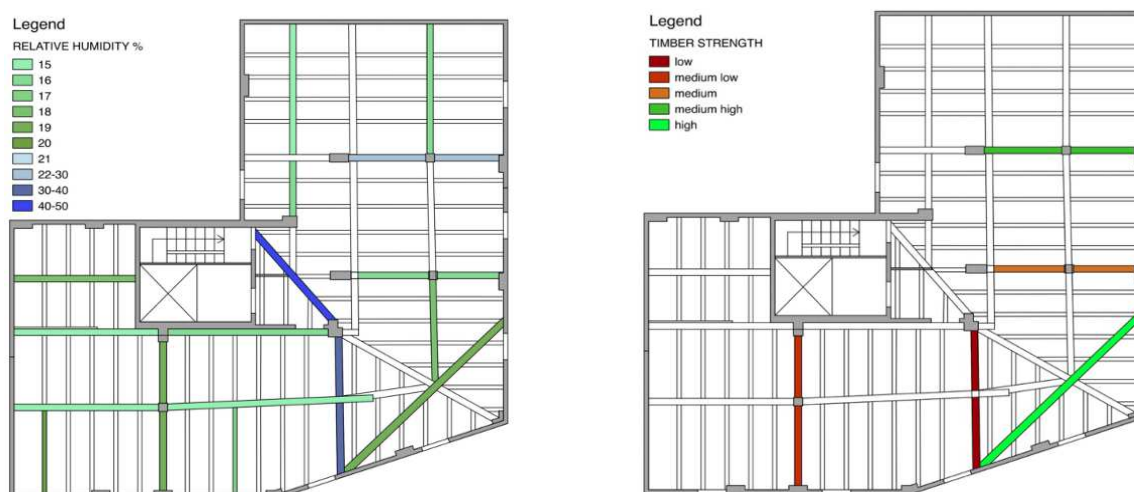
Mapas SIG a escala arquitectónica. Caracterización de vigas de madera de una vivienda.
